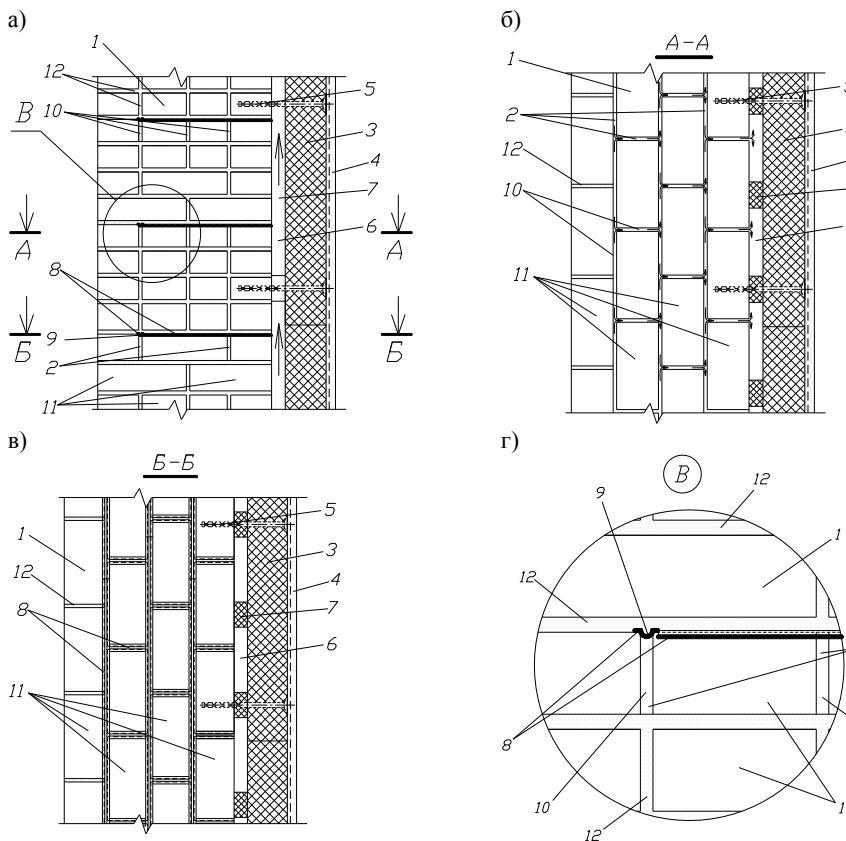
Схема наружной стены с системой воздушных каналов в теле кирпичной кладки:
